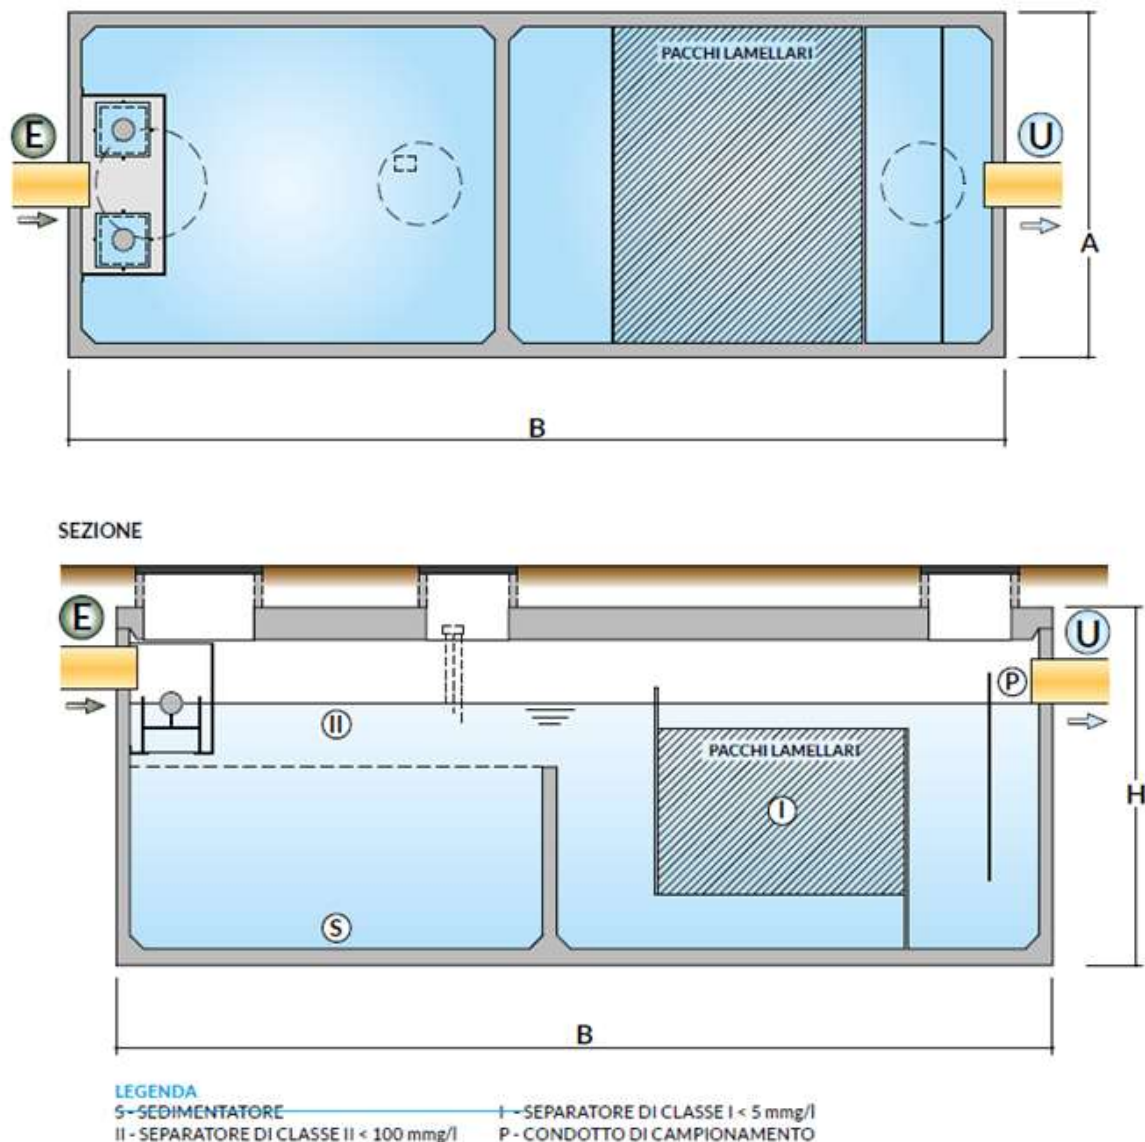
Pianta e sezione dell'impianto di trattamento acque di prima pioggia
